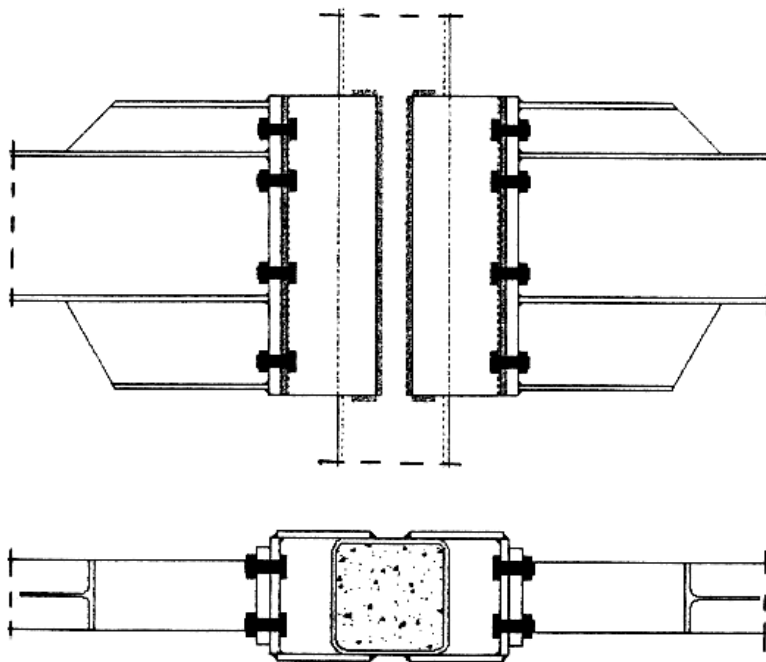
Болтовое фланцевое сопряжение двутавровых ригелей с трубобетонной колонной коробчатого сечения
